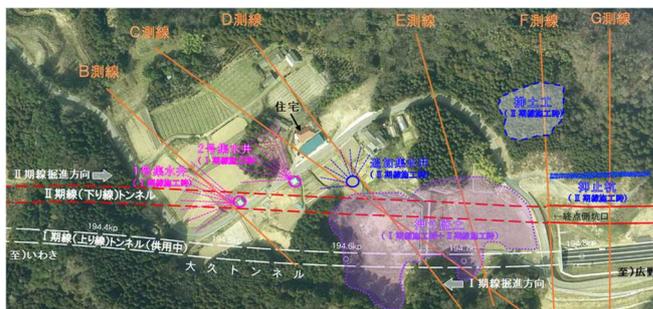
Ⅰ・Ⅱ期線施工時の地すべり対策工
